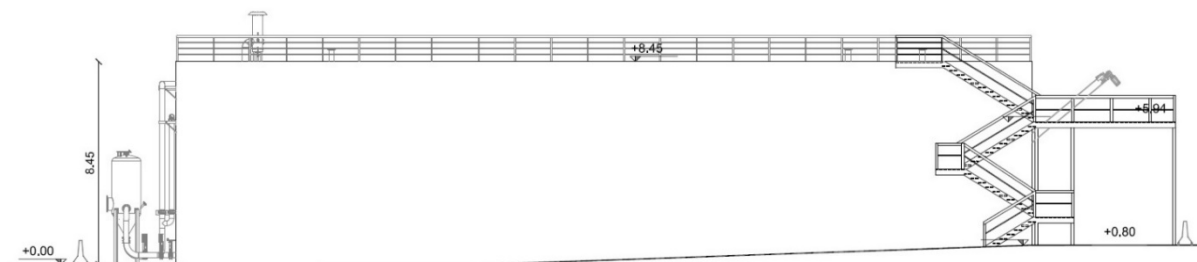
Planimetria della sezione di Digestione Anaerobica
